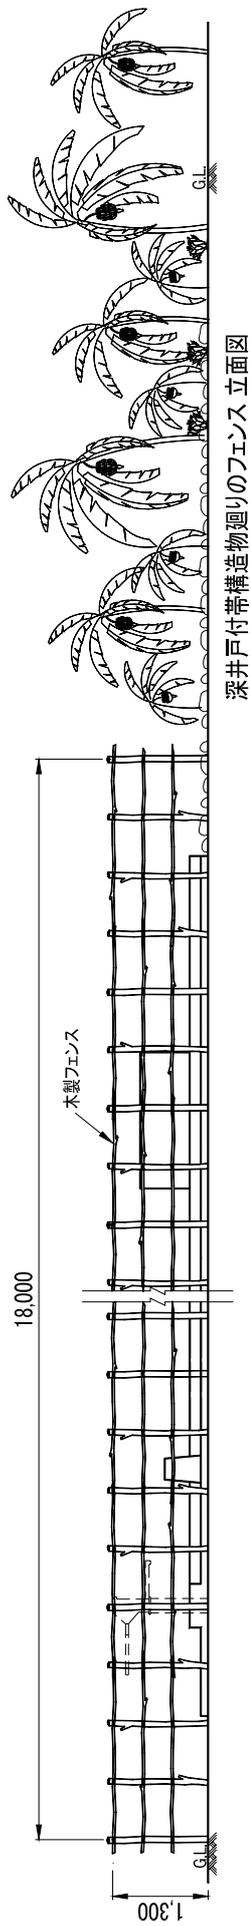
2 6 深井戸付帯構造物 平面・断面図
